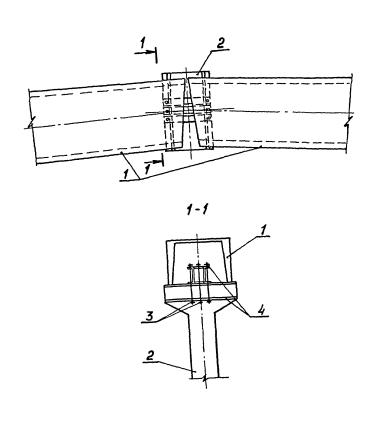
Усиление консолей железобетонной колонны покрытия резервуара
